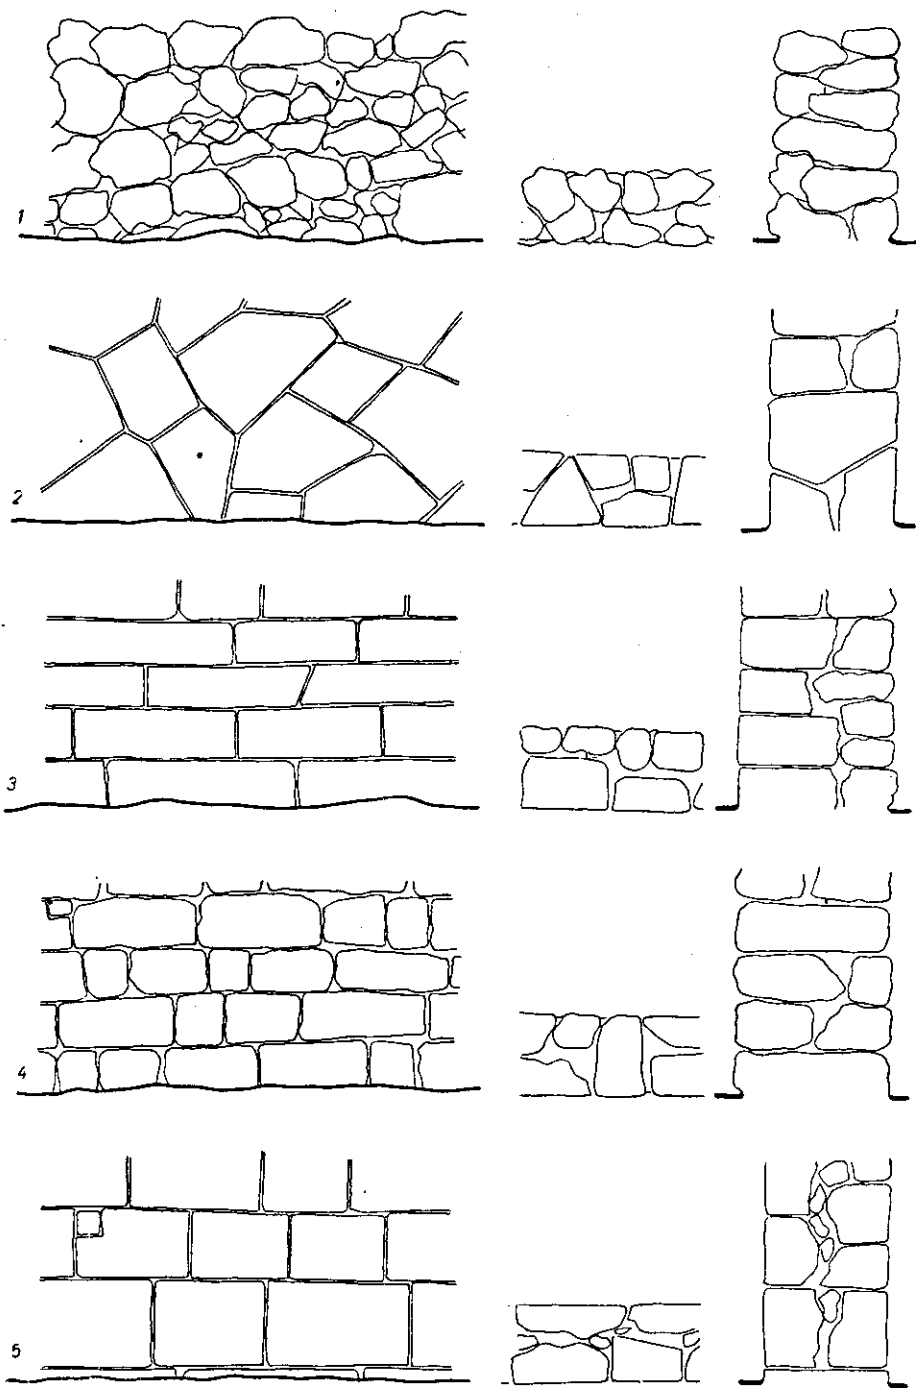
Система кладок. Фасад, план, поперечний розріз.
